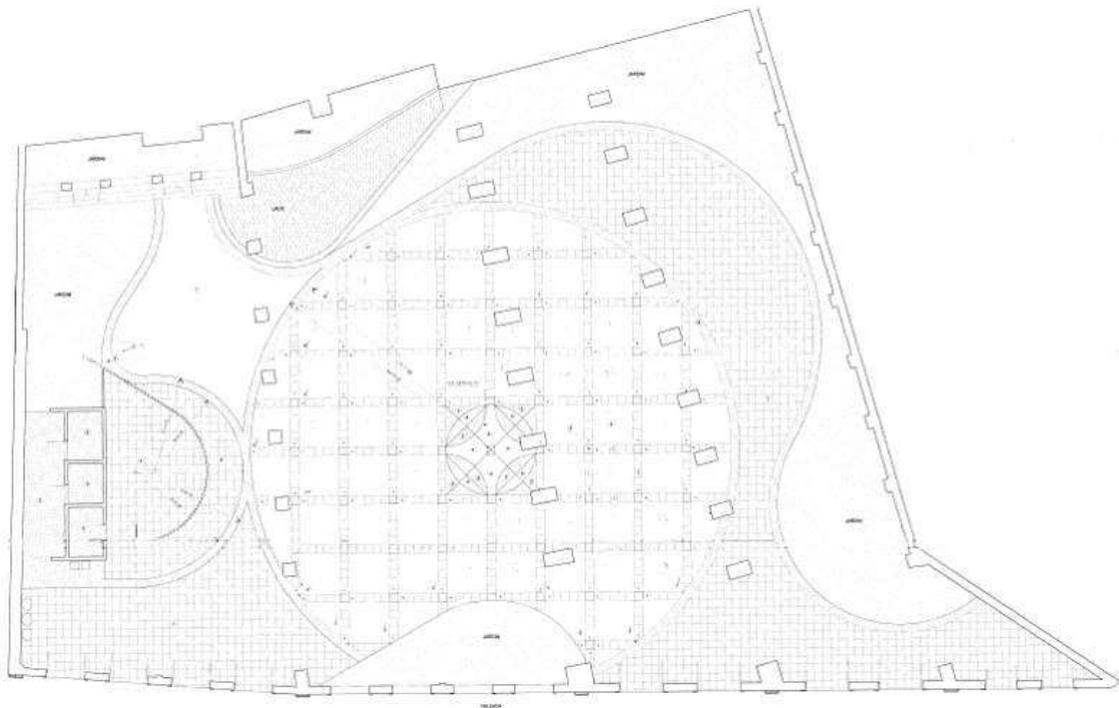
Planta de paginação de piso do andar térreo do Morada das Artes
